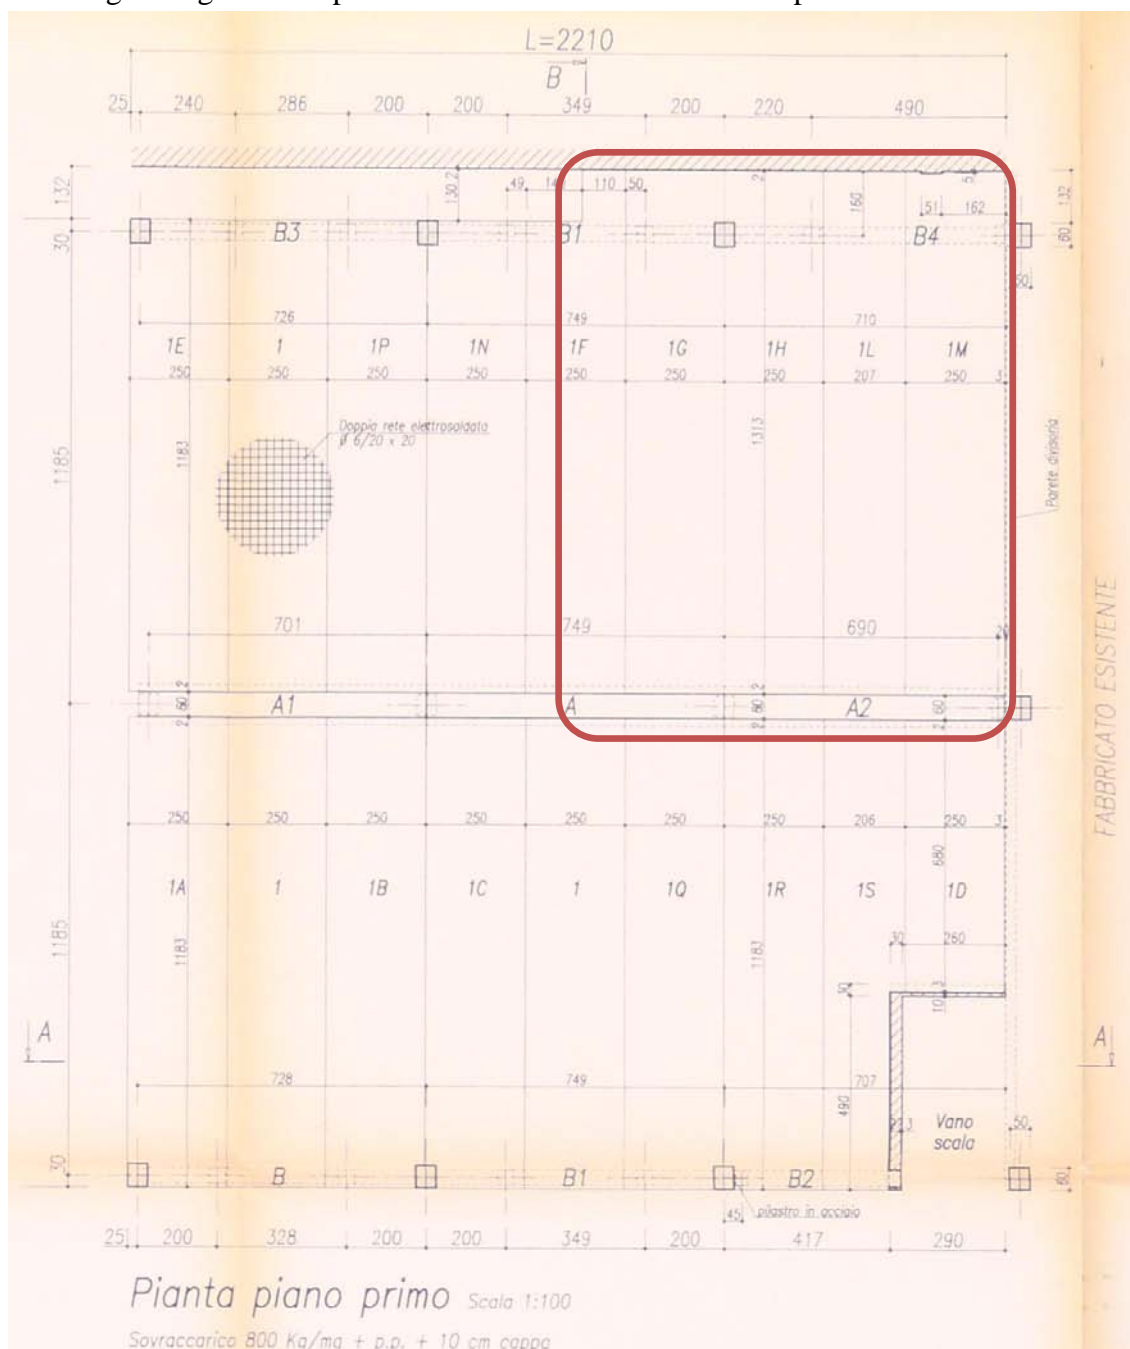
Particolare di A.1996.cap.sa.T04 - Pianta pilastri - Pianta piano primo - Ubicazione tegoli Tipo 2
